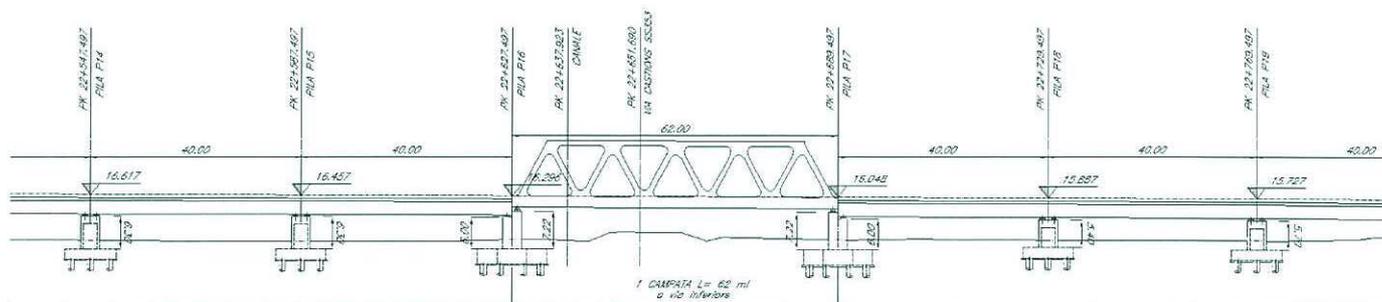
Prospetto dell'attraversamento principale con campata L=62.0m.
